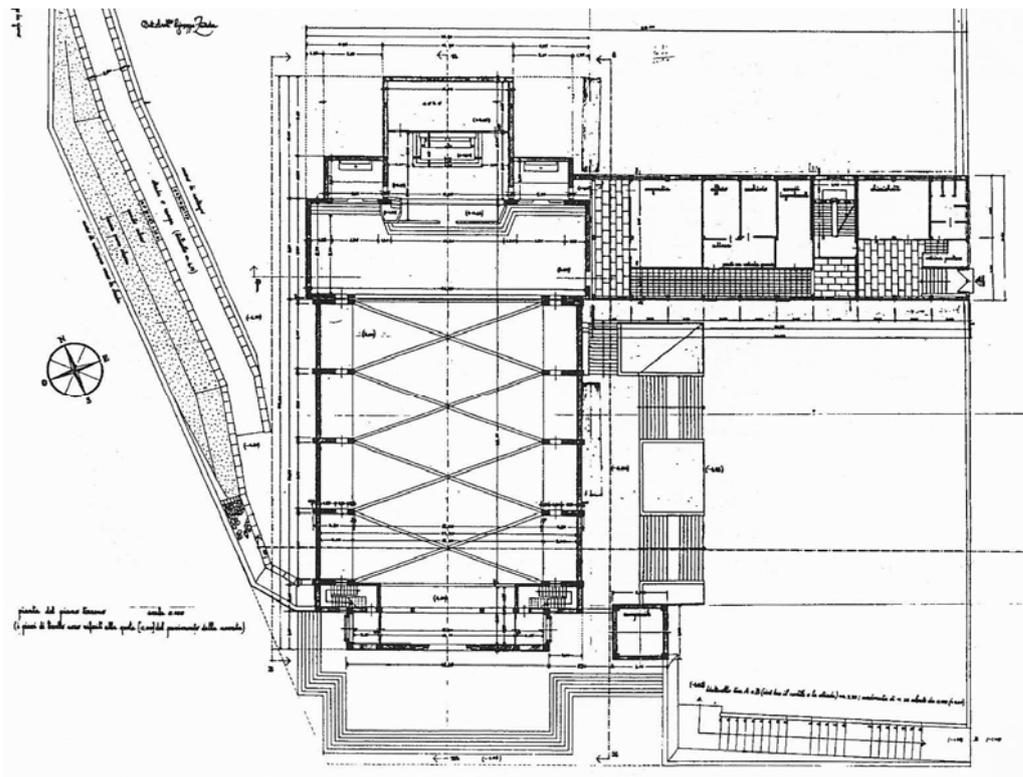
1962 - Progetto della chiesa, pianta e prospetto (APZ)
